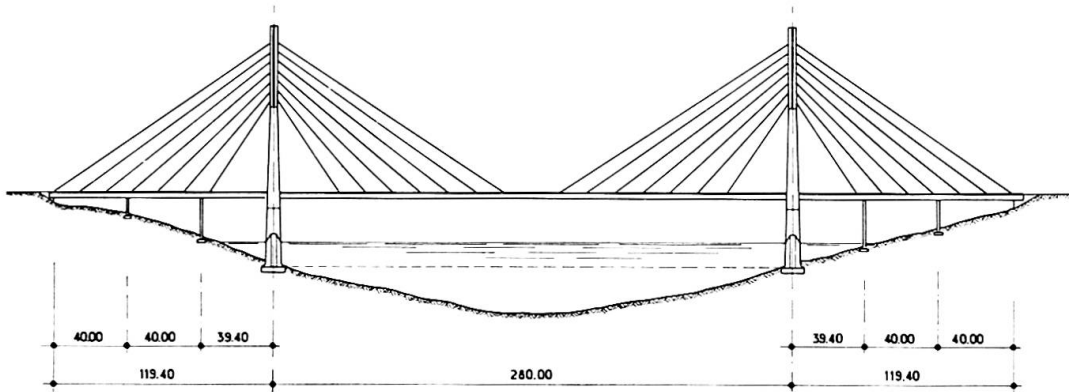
Coupe longitudinale du pont sur le Rio CARONI (portée : 280 m)
